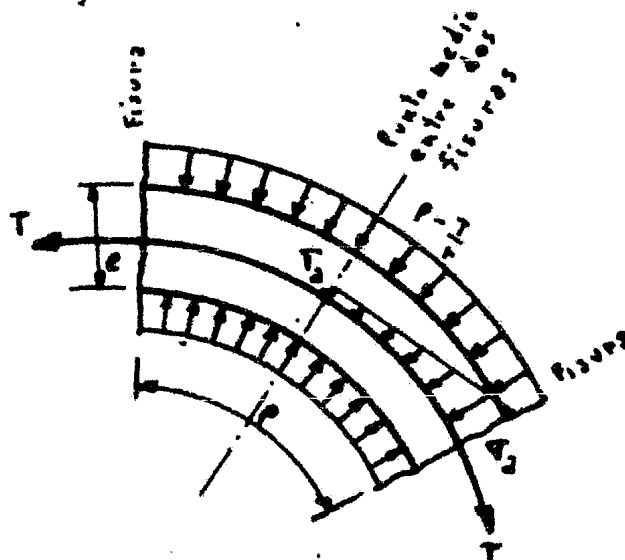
Esquema de cálculo del revestimiento de una galería de presión. El concreto está fisurado, pero resiste entre fisuras para el caso de presión interior.
